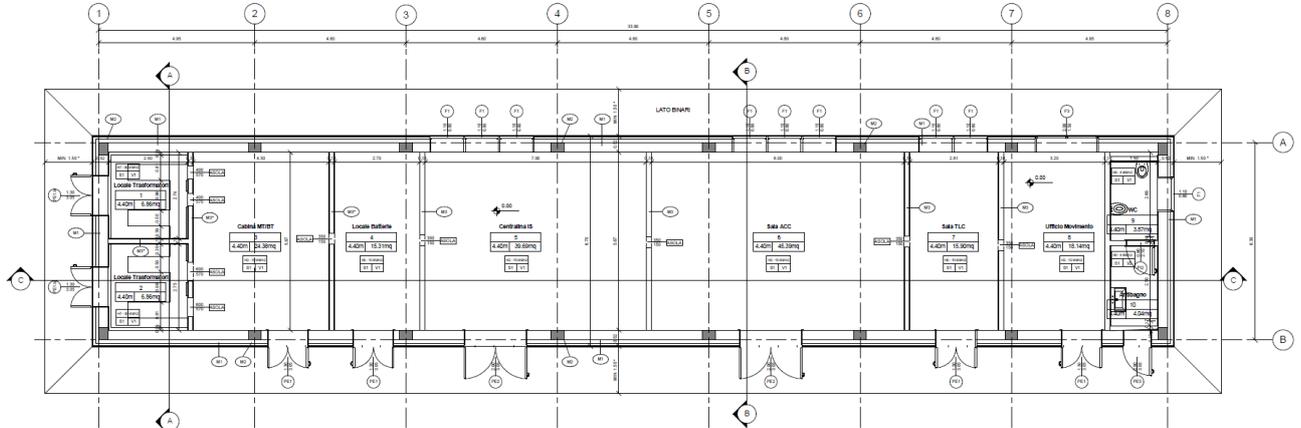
GA Nord – Pianta Architettonica Piano terra
